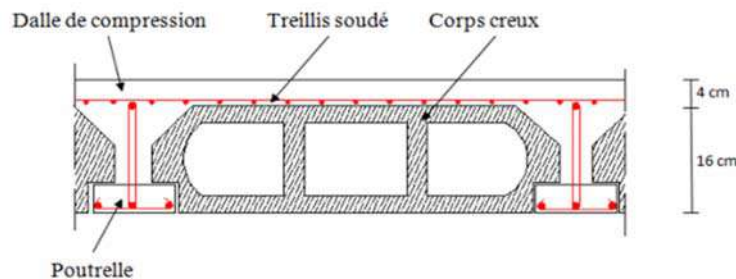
Coupe transversale d'un plancher en corps creux (cas général)
